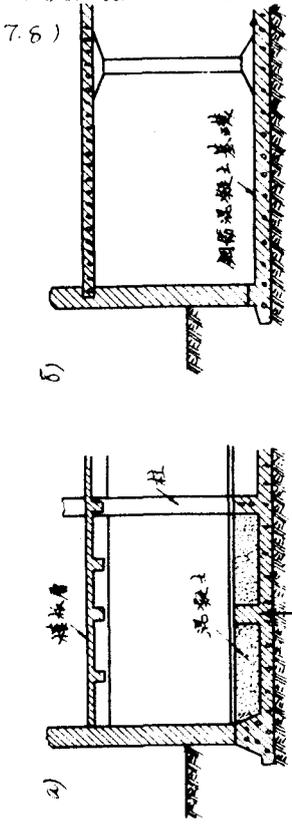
滿堂紅式鋼筋混凝土板狀基礎
